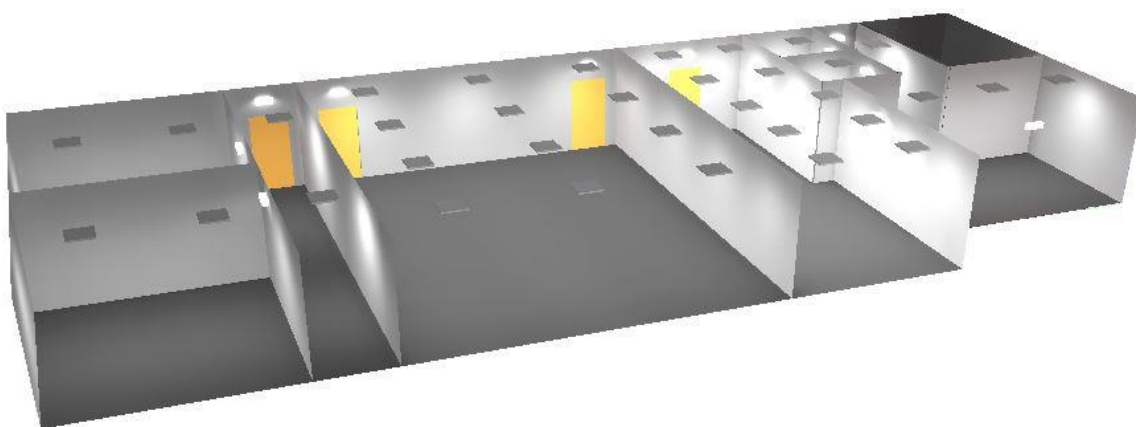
Vista 3D de la iluminación en la Planta Baja
